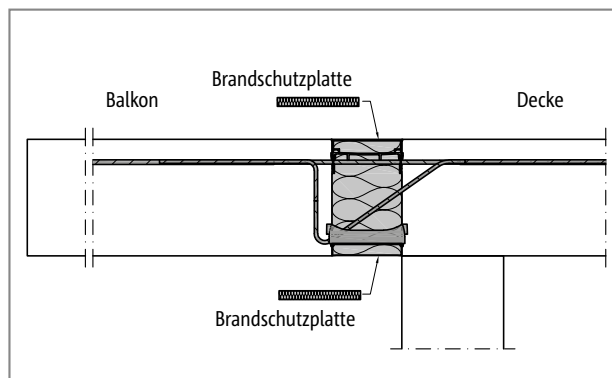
Schöck Isokorb® XT Typ K bei R0: nachträgliche Sanierung mit Brandschutzplatten
